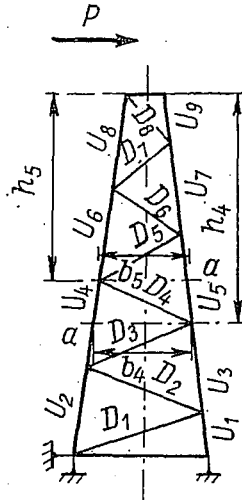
К расчету ферм методом сечений выше моментной точки
